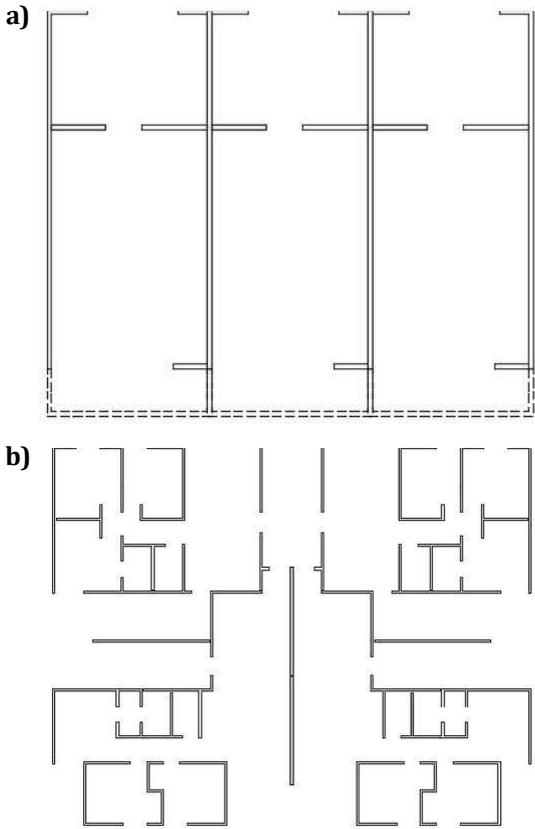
(a) Planta de tipología de vivienda de 2 pisos. (b) Planta de la tipología de edificio de 5 pisos
